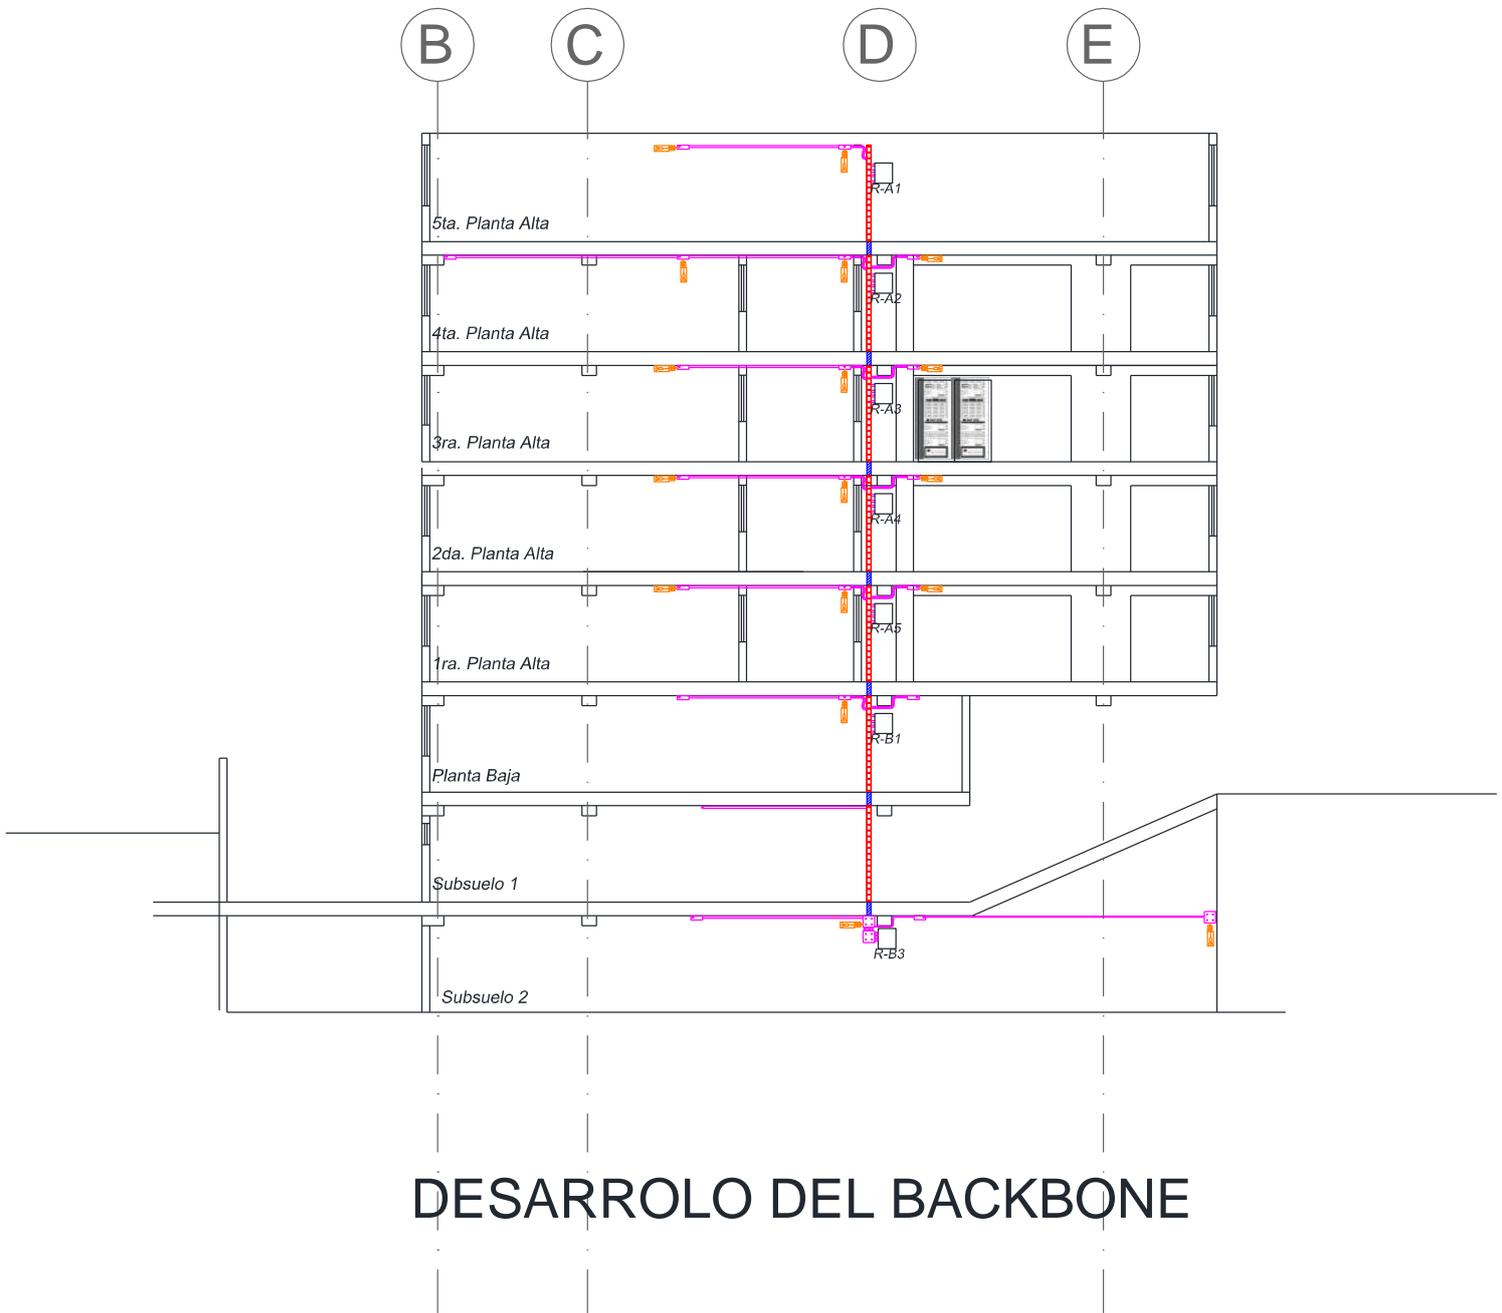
Plano del desarrollo vertical - Backbone.
